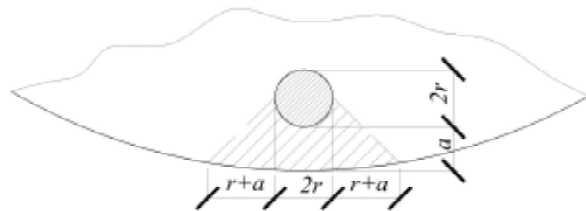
К определению нагельного эффекта, a – защитный слой продольной арматуры
